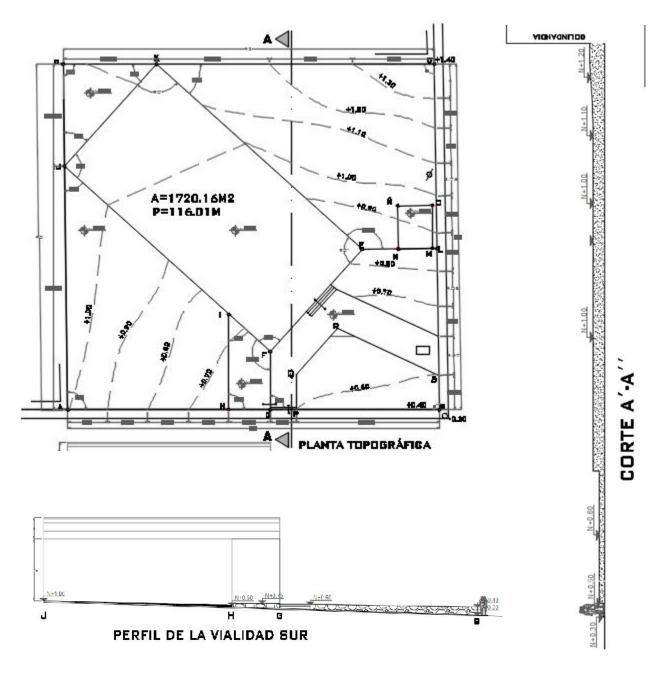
PLANO TOPOGRÁFICO Y PERFILES PROPIAS
